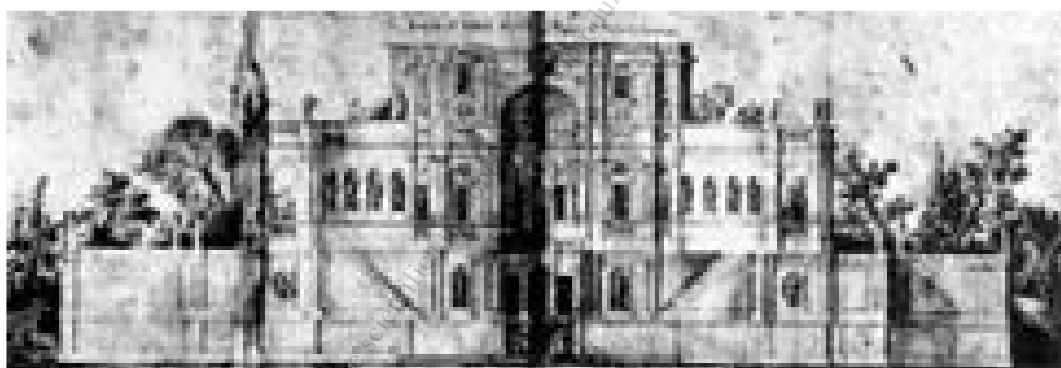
Casino Sacchetti: prospetto (P. Bracci, 1719, Montreal, Centre Canadien d'Architecture)
